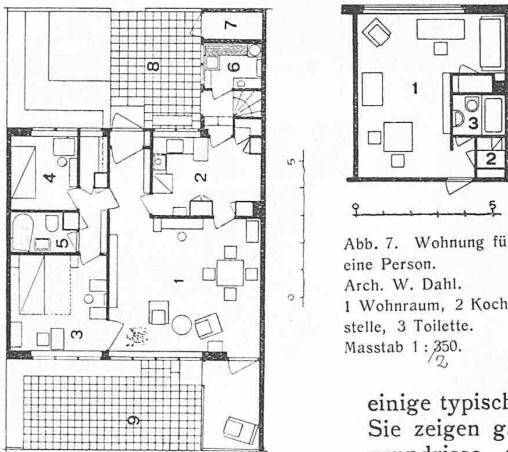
Grundriss Almqvist. — 1 : 250. Dieser Plan ist hier hochkant gestellt zum leichteren Vergleich mit Abb. 12. Legende: 1 Wohnr., 2 Küche, 3 Schlafr., 4 Mädchenzim., 5 Bad-W. C., 6 Spür., 7 Velorium, 8 Wirtschaftshof hinten, 9 Gartenterrasse vorn.
